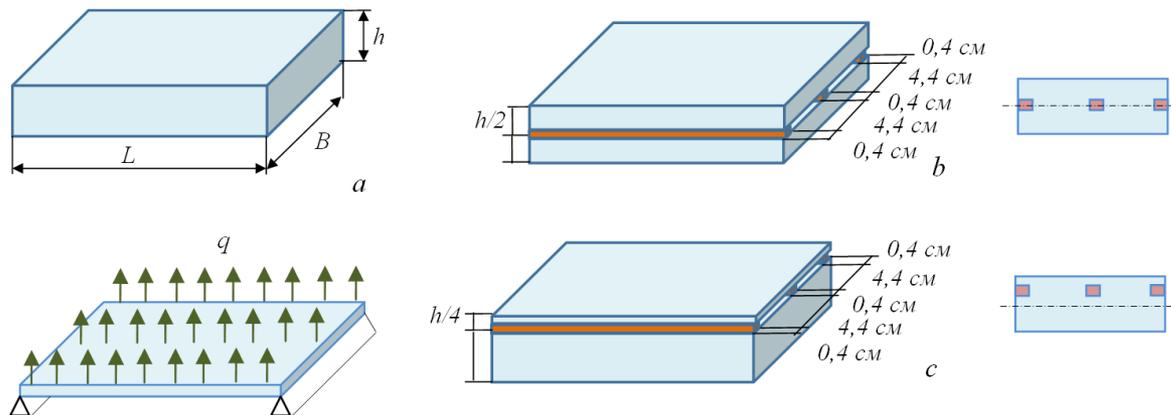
Варианты расчета армированной пластины: без армировки – а); армировка на срединной поверхности – б), эксцентричная – с)
